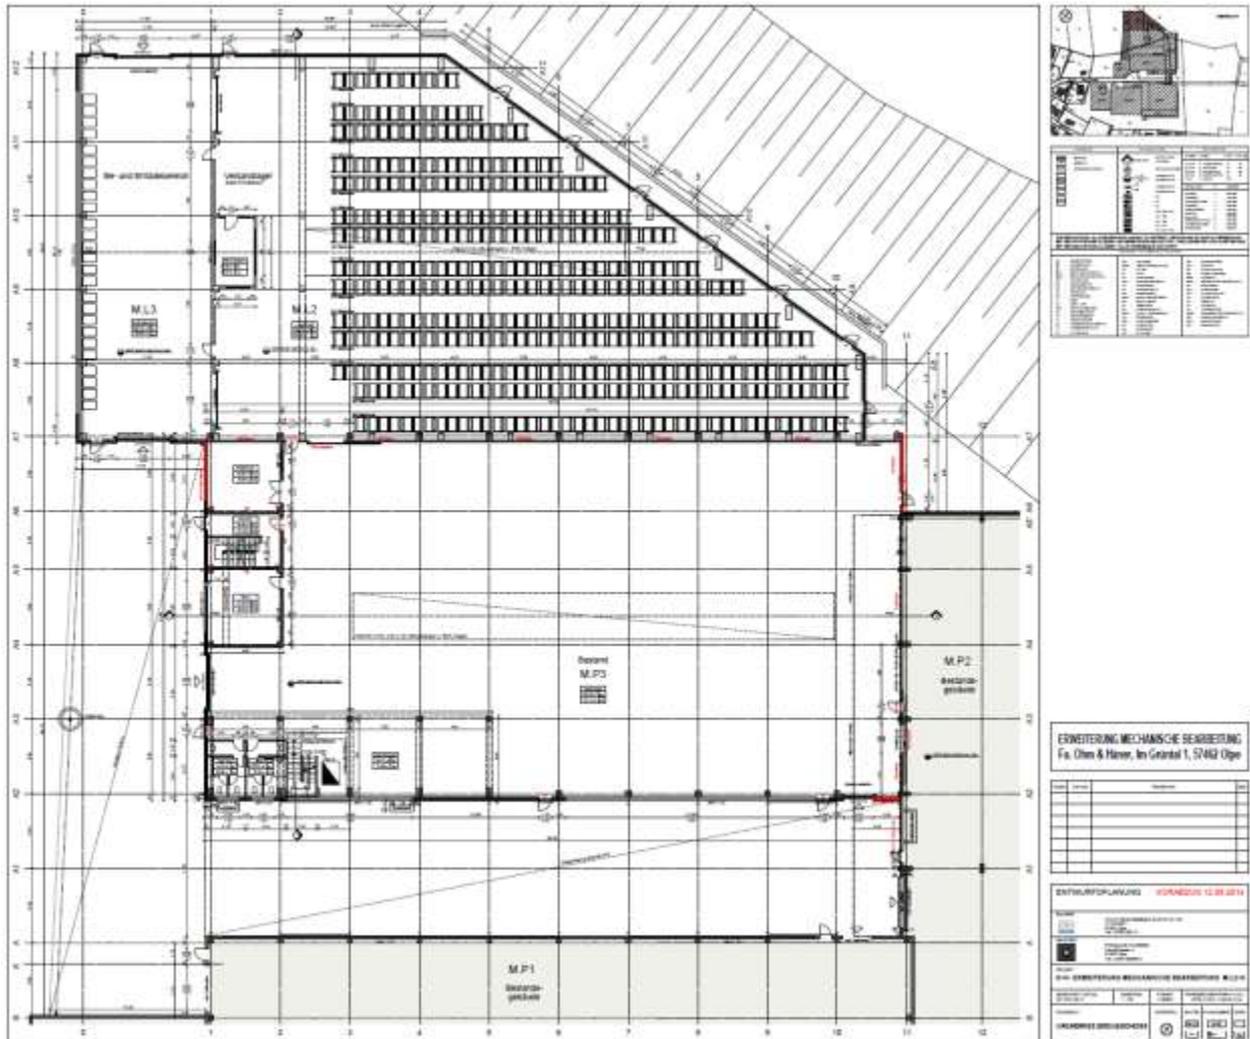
Erweiterung mechanische Bearbeitung – Grundriss Erdgeschoss
